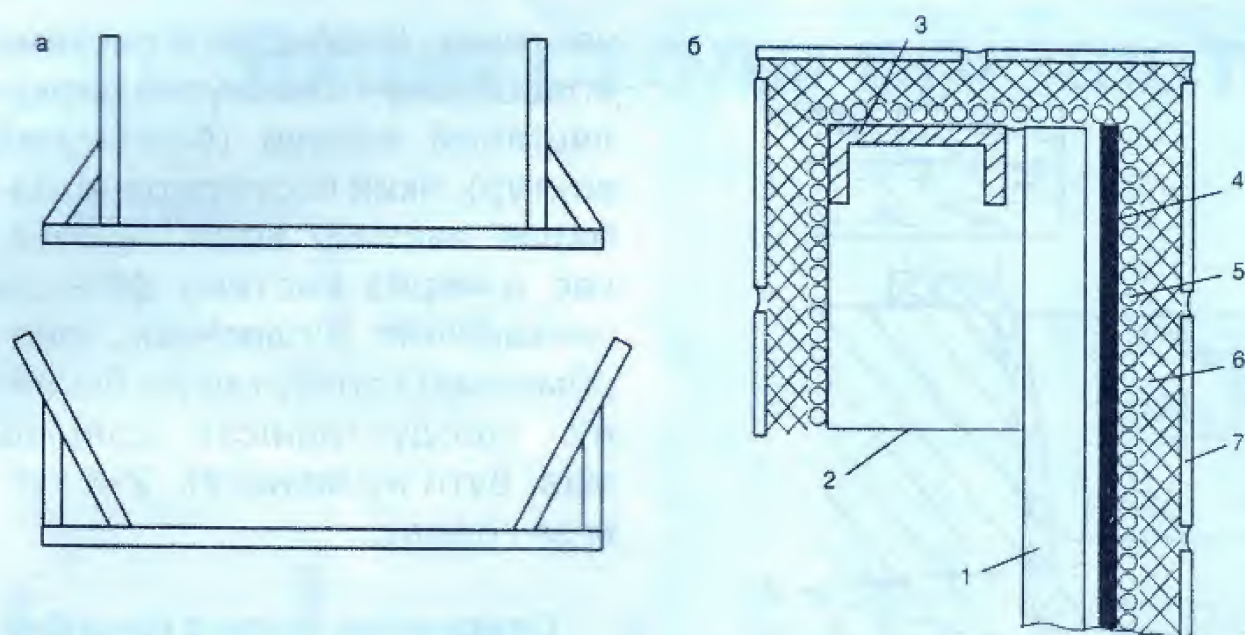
Конструктивні елементи басейну зі стальним корпусом і облицюванням керамічною плиткою: а - варіанти шпангоутів; б - фрагмент розрізу 1 - стояк шпангоута; 2 - зовнішній каркас; 3 - верхня обв'язка; 4 - лист корпуса; 5 - штукатурна сітка; 6 - розчин; 7 - керамічна плитка
